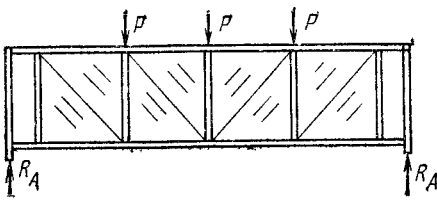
Работа отсека тонкостенной балки на Q и M
